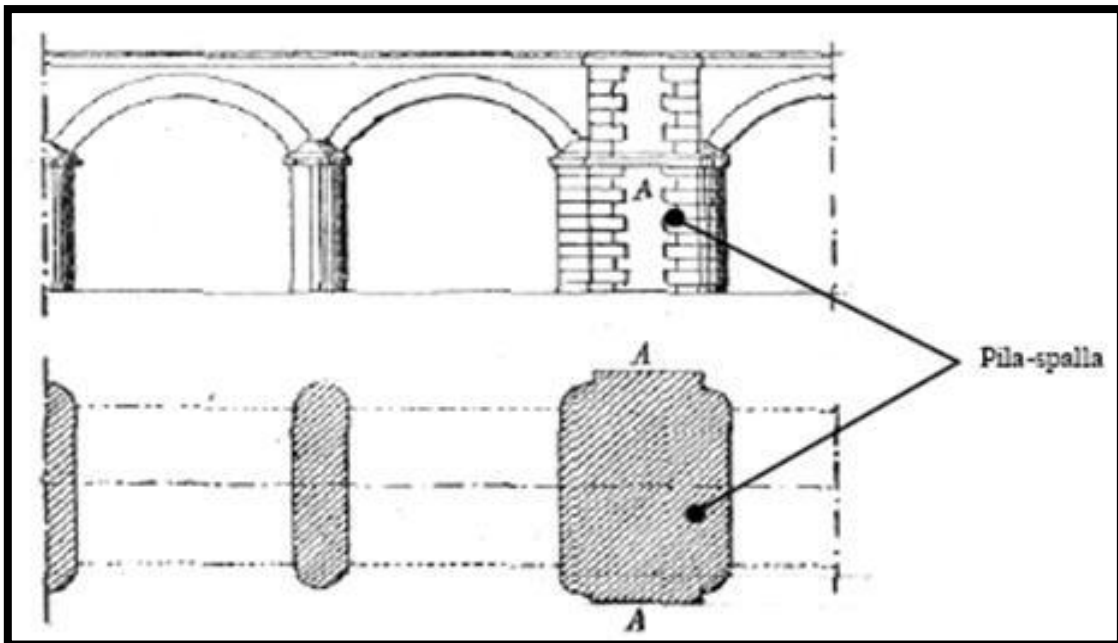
Pila-Spalla. (Fonte: BAGGI, G., 1926.)
